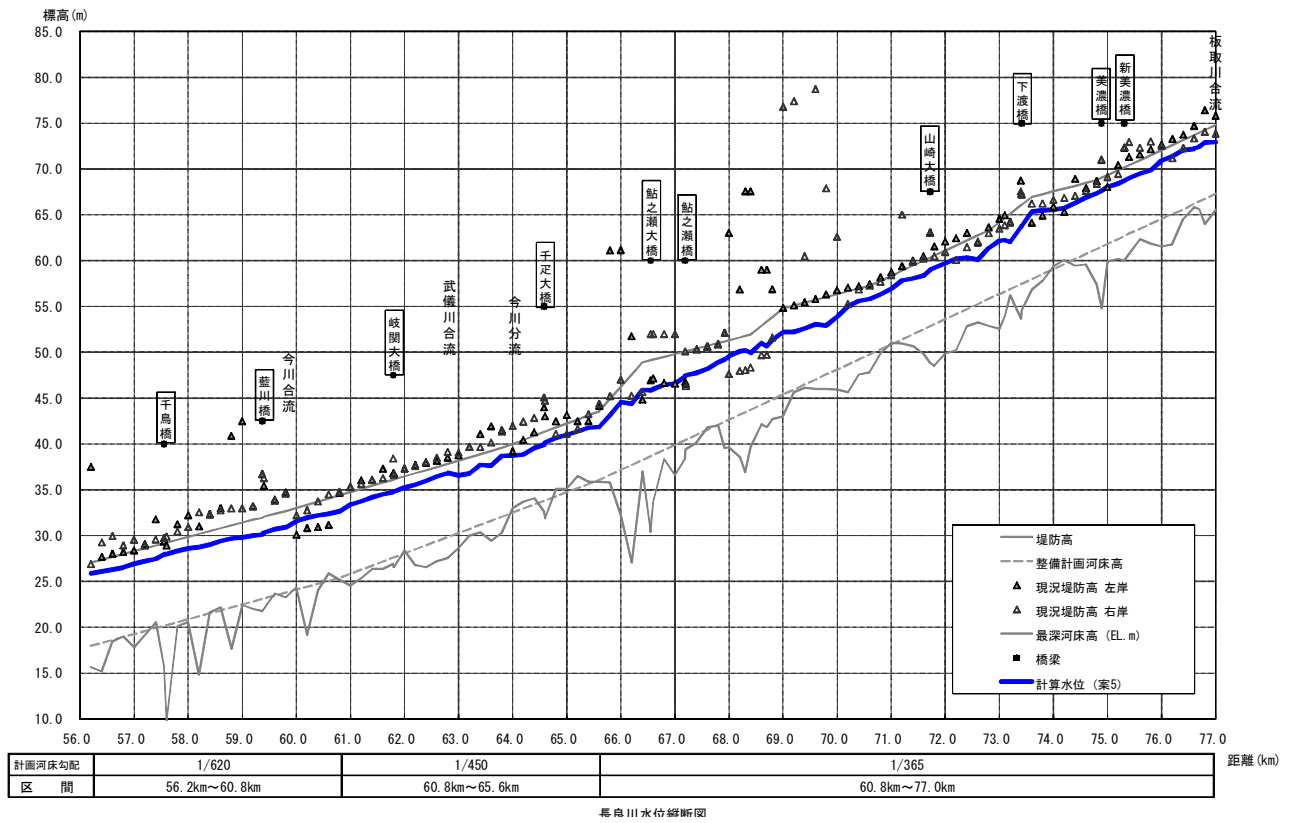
河道改修+遊水地+水田貯留案 縦断面図 (56km~77km)
